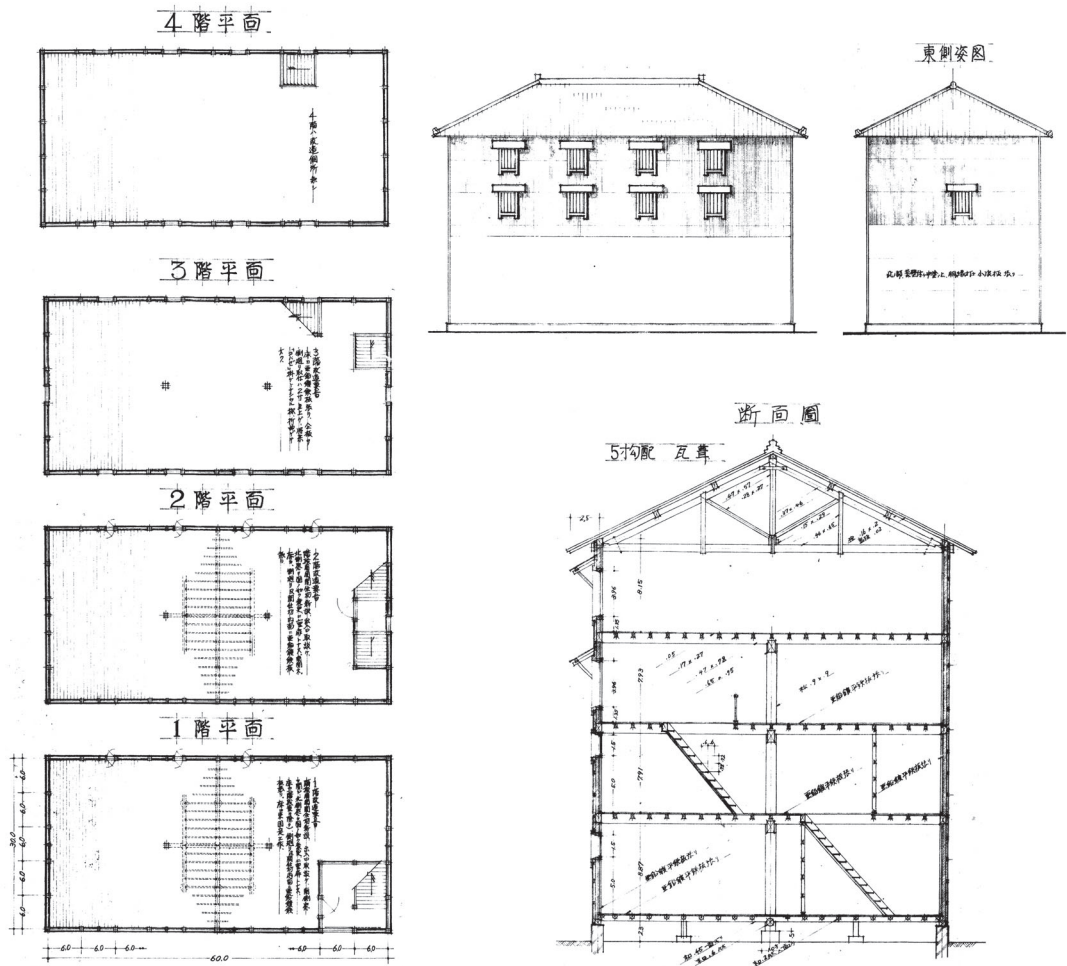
1号繭倉庫 各階平面図、南側立面図、東側立面図 1/400、断面図 1/200
